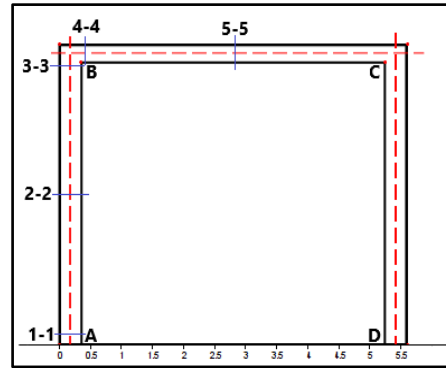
Secciones críticas en los elementos estructurales de la alcantarilla.
